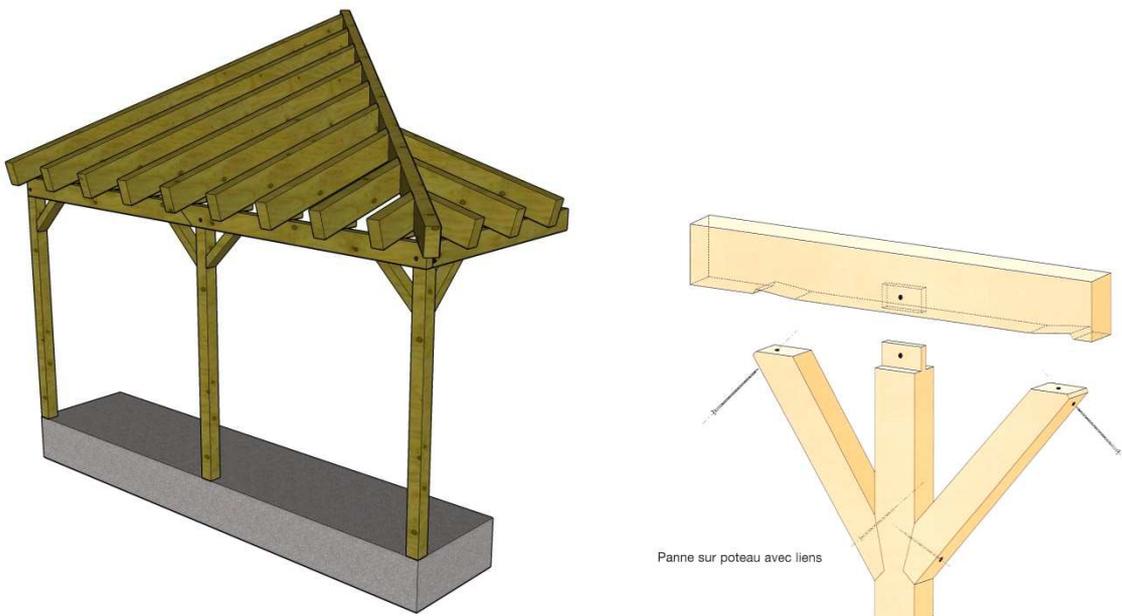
Schémas de principe de réalisation de la charpente de toiture sur terrasse / assemblage poutre-poteau-liens
